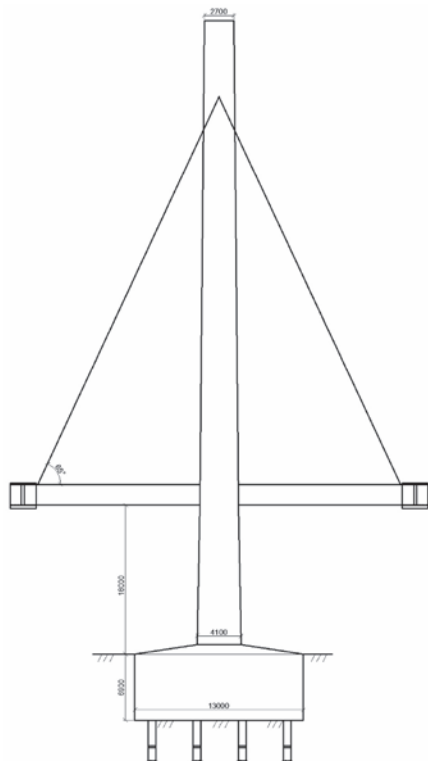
Навісне бетонування прогонової будови до місця кріплення першої ванти
